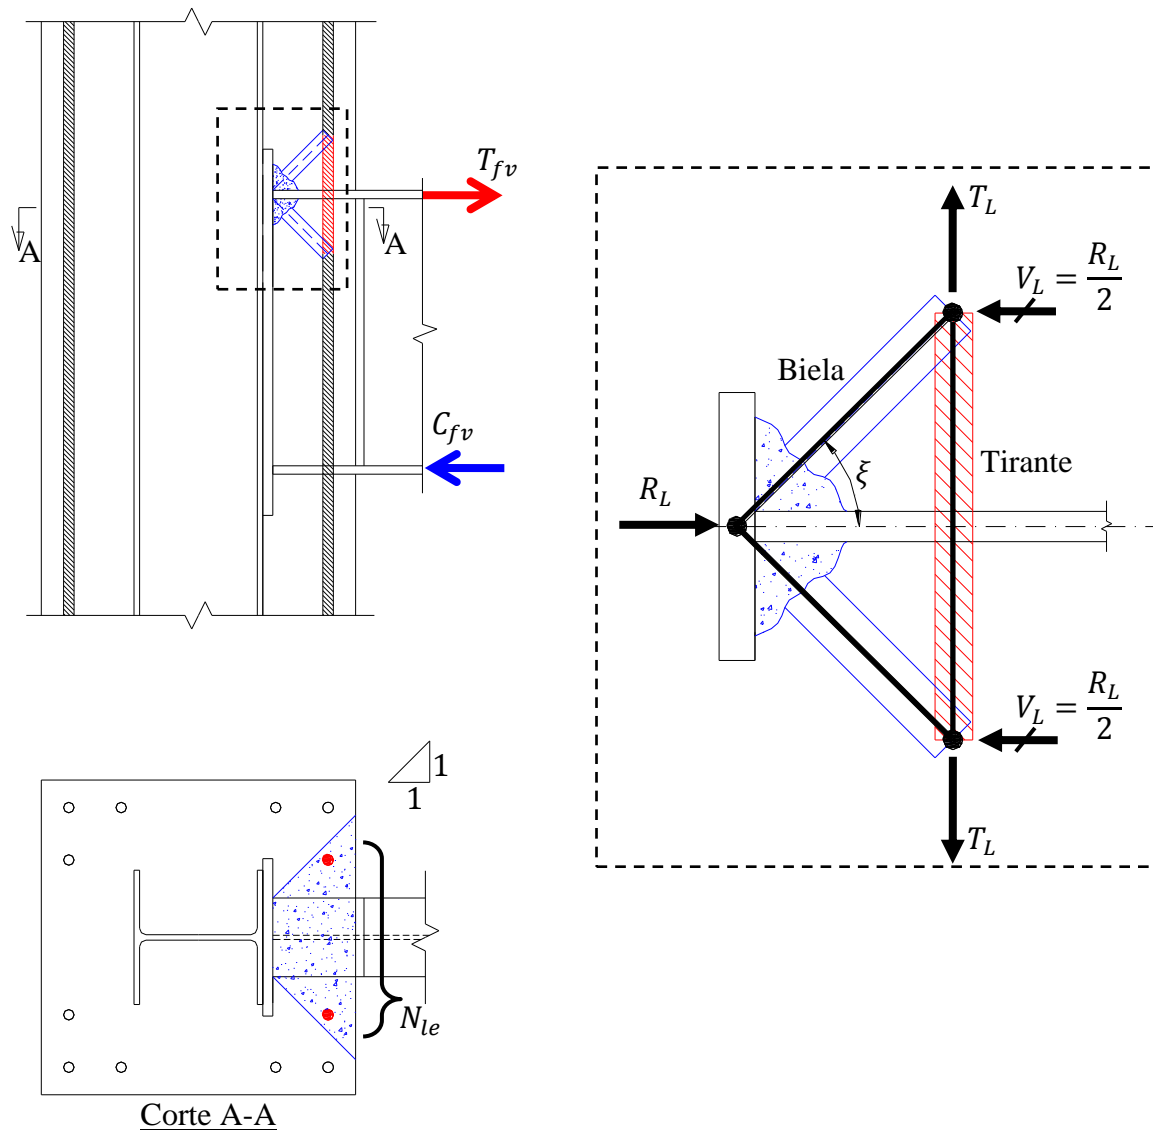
Mecanismo biela-tirante formado pelas armaduras longitudinais
